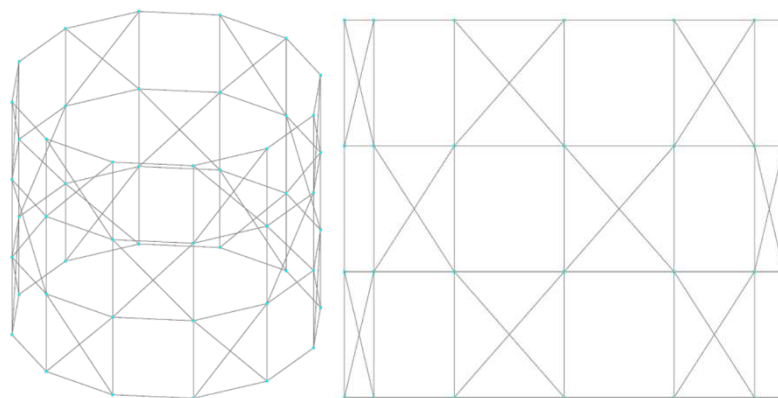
Фрагмент расчетной схемы крестовой блочной решетки
